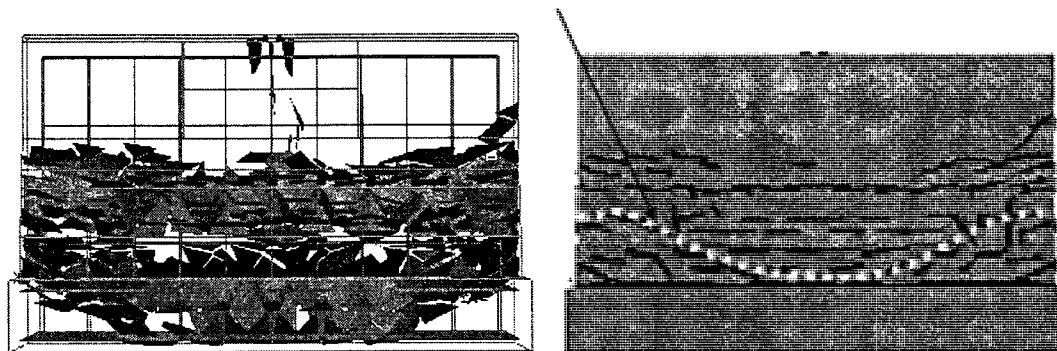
23: Fissuration du parapet de référence en BO 35MPa
